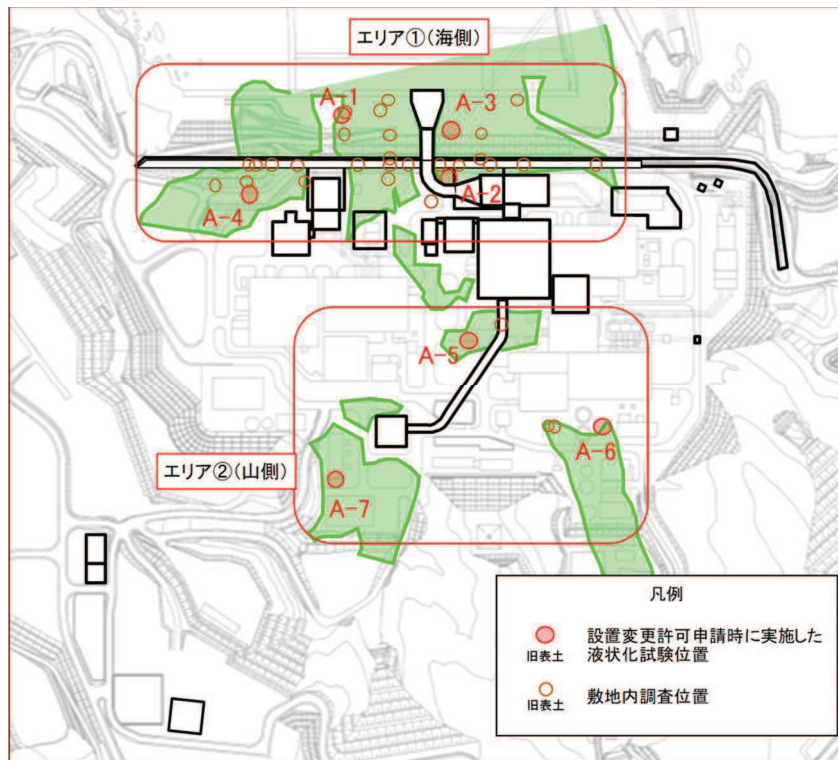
旧表土の液状化強度試験位置及び敷地内調査位置の平面図
